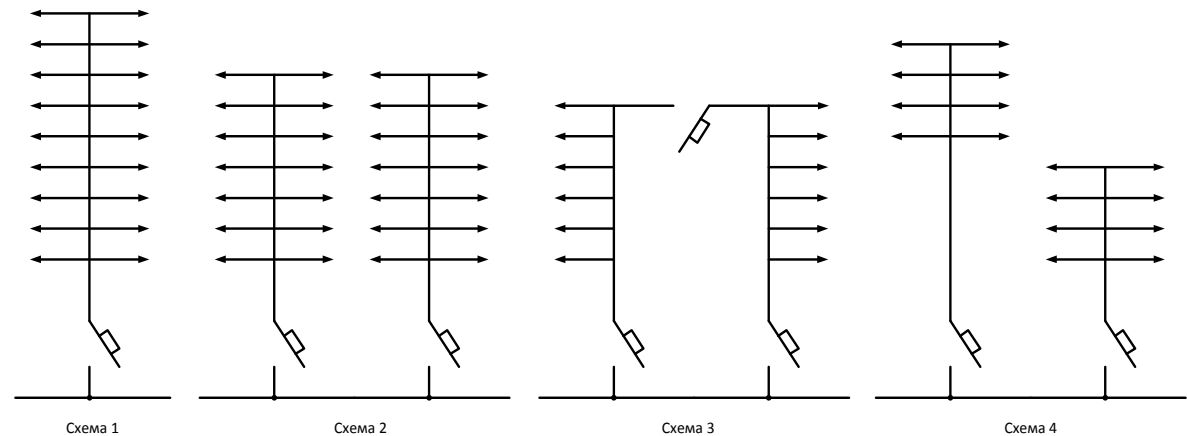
Принципиальная схема электроснабжения жилых домов высотой 17 этажей и более:
